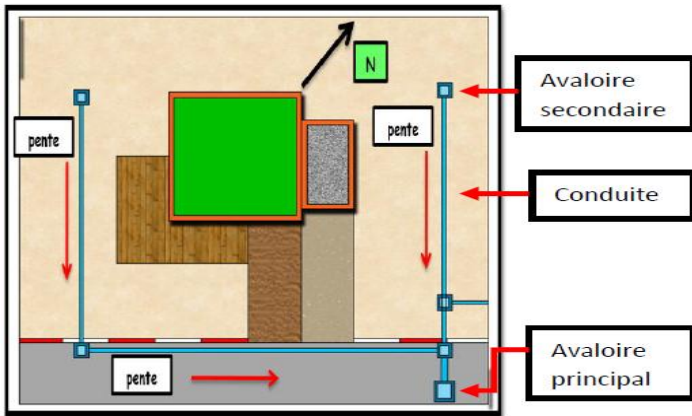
plan représente réseau d'évacuation des eau pluviale,
